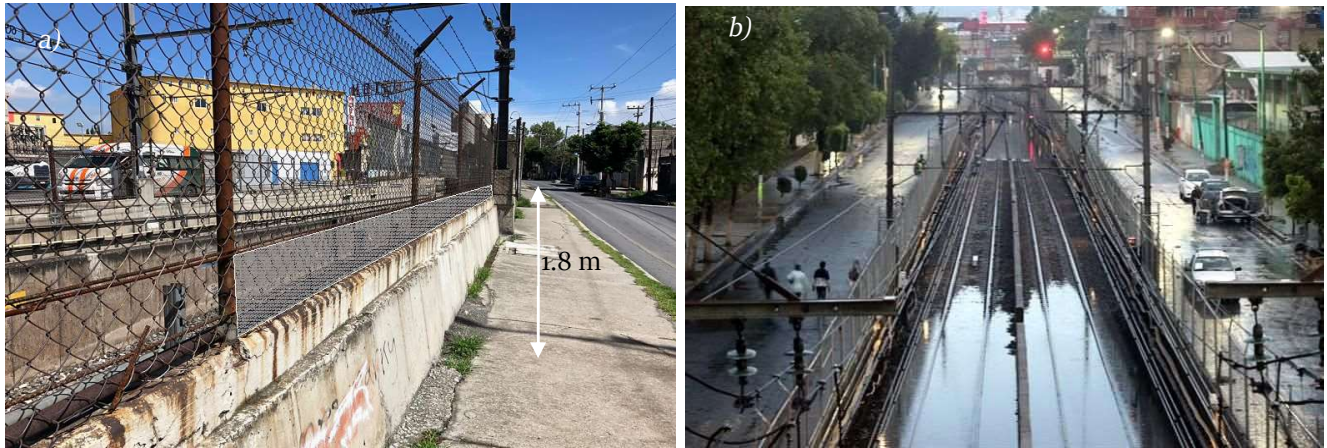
a) Propuesta Interestación Los Reyes – Santa Marta b) Falla
